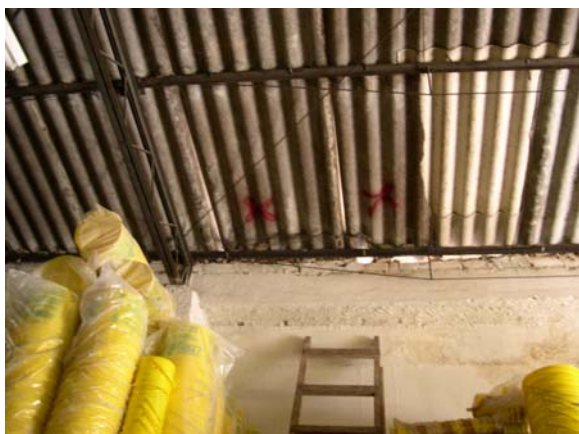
Telhado do galpão da DF Impermeabilizantes. As amostras estão indicadas com “x” vermelho.
